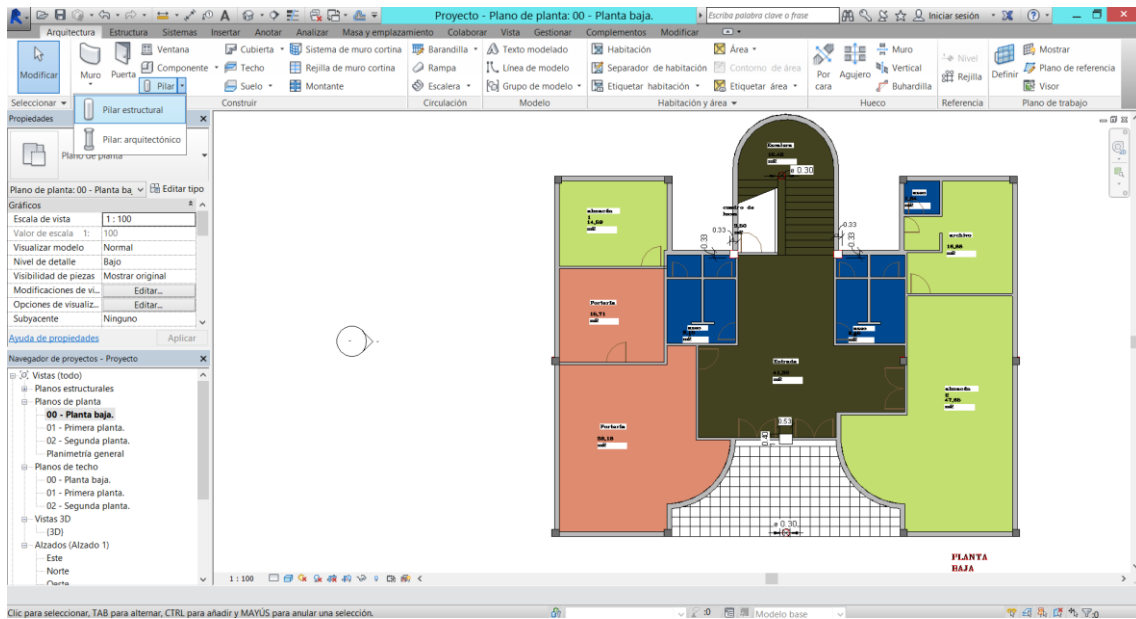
Pilar estructural. Fuente: Elaboración propia.
